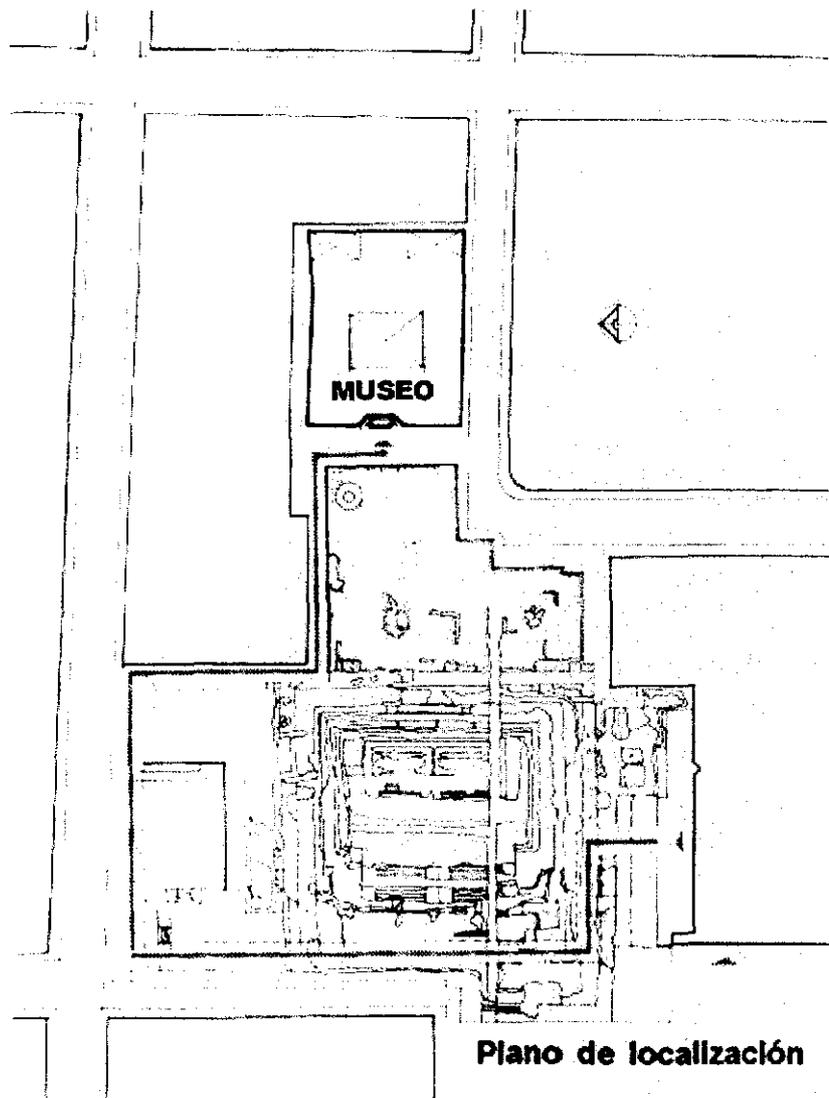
Planta de conjunto de la zona y museo de sitio.
